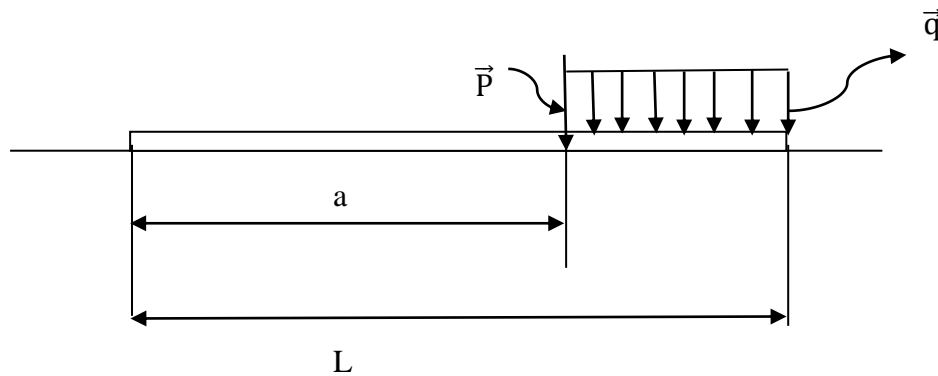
poutre d'une rigidité fini d'une longueur limite
